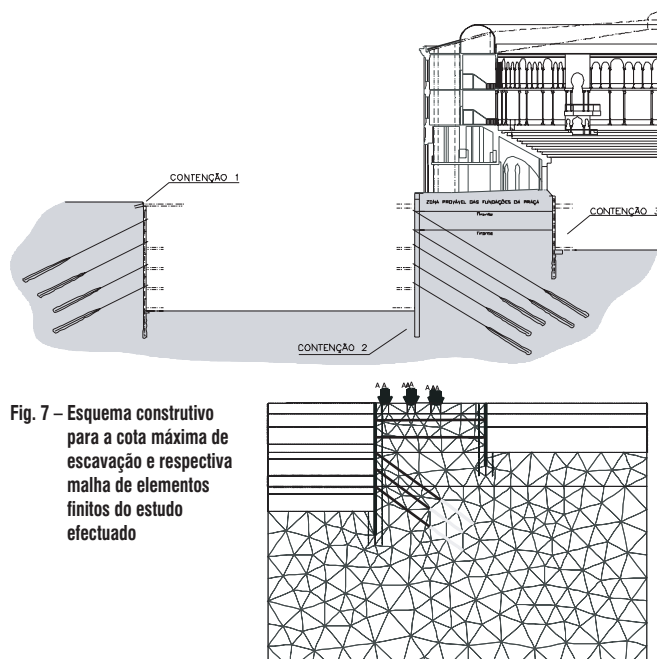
Esquema construtivo para a cota máxima de escavação e respectiva malha de elementos finitos do estudo efectuado
